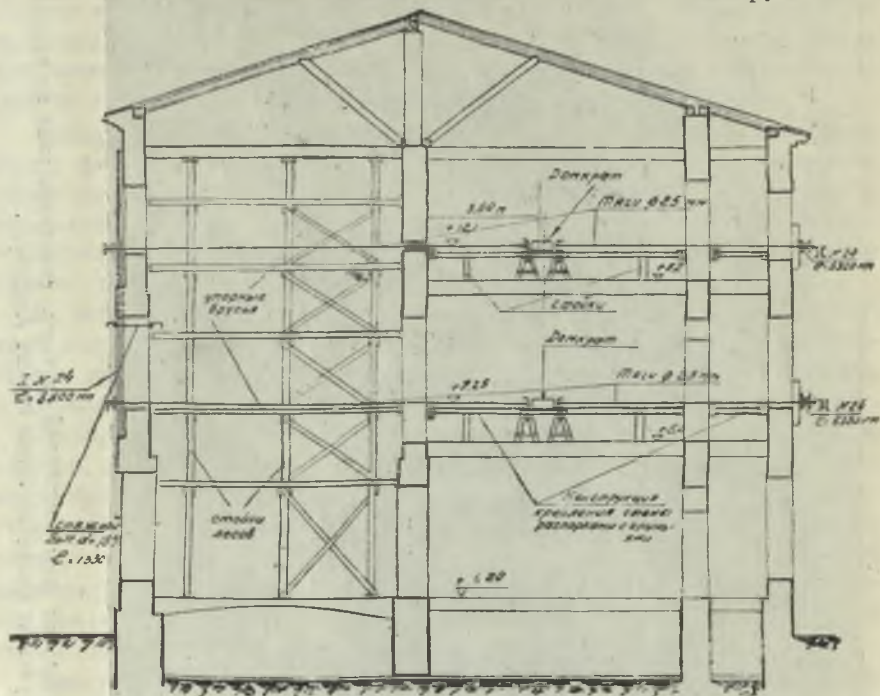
Схема расположения натяжных устройств при выпрямлении фасадной стены здания Ленэнерго.
